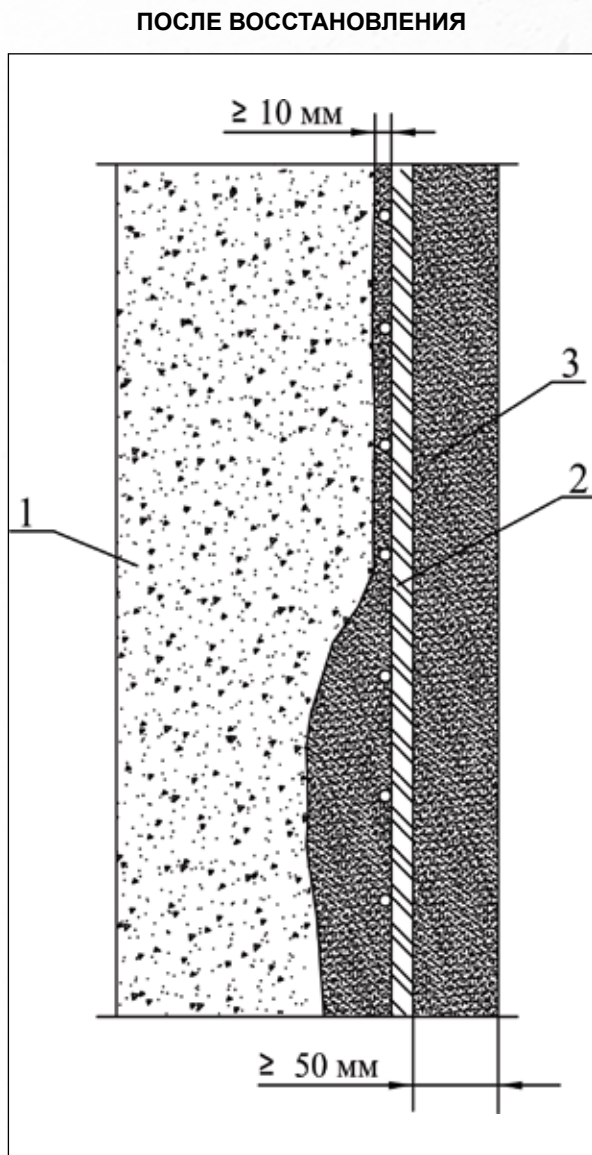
Схема разрушенного бетона: 1 – железобетонная конструкция; 2 – арматура; 3 – «Скрепа М500 Ремонтная».
